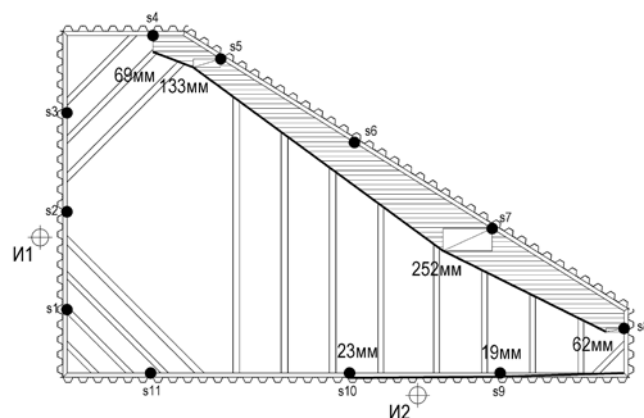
Совмещенная схема расположения геотехнического оборудования с эпюрой перемещения верха шпунта на момент полного вскрытия котлована
